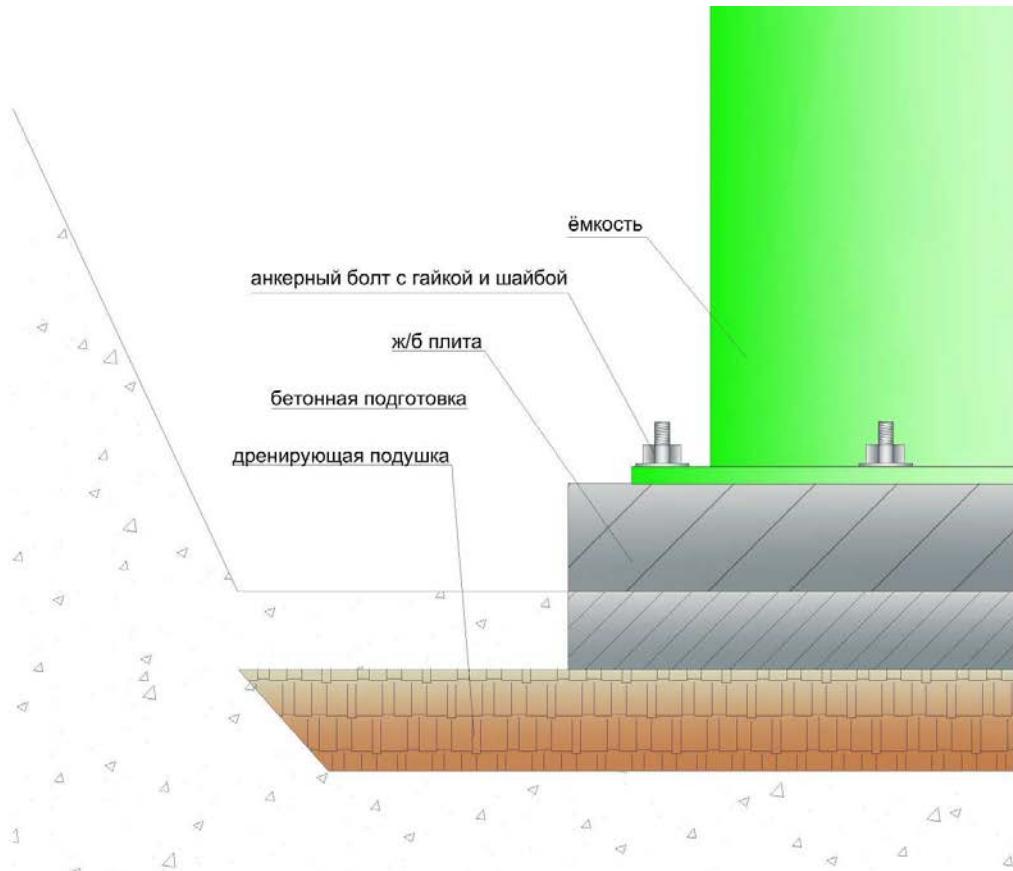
Крепление изделия к фундаментной ж/б плите
